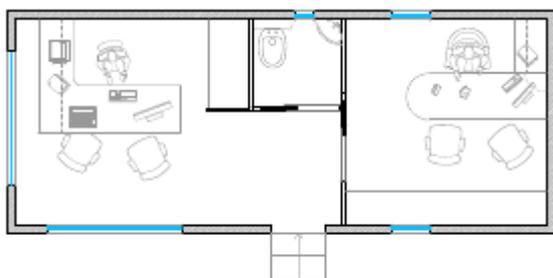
Sistemazione tipologica dei locali da impiantare nelle aree di cantiere
